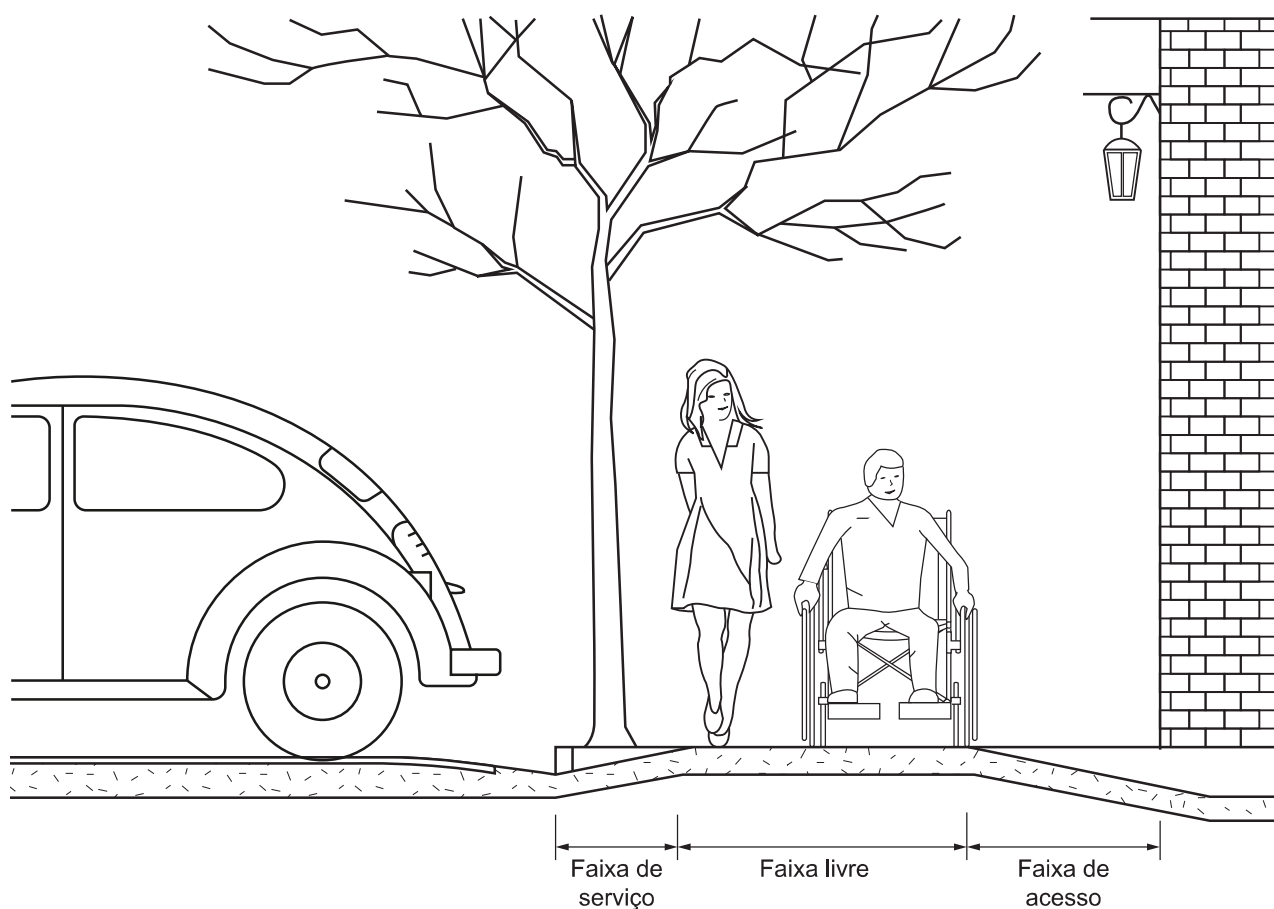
Faixas de uso da calçada – Corte6.12.4 Acesso do veículo ao lote
